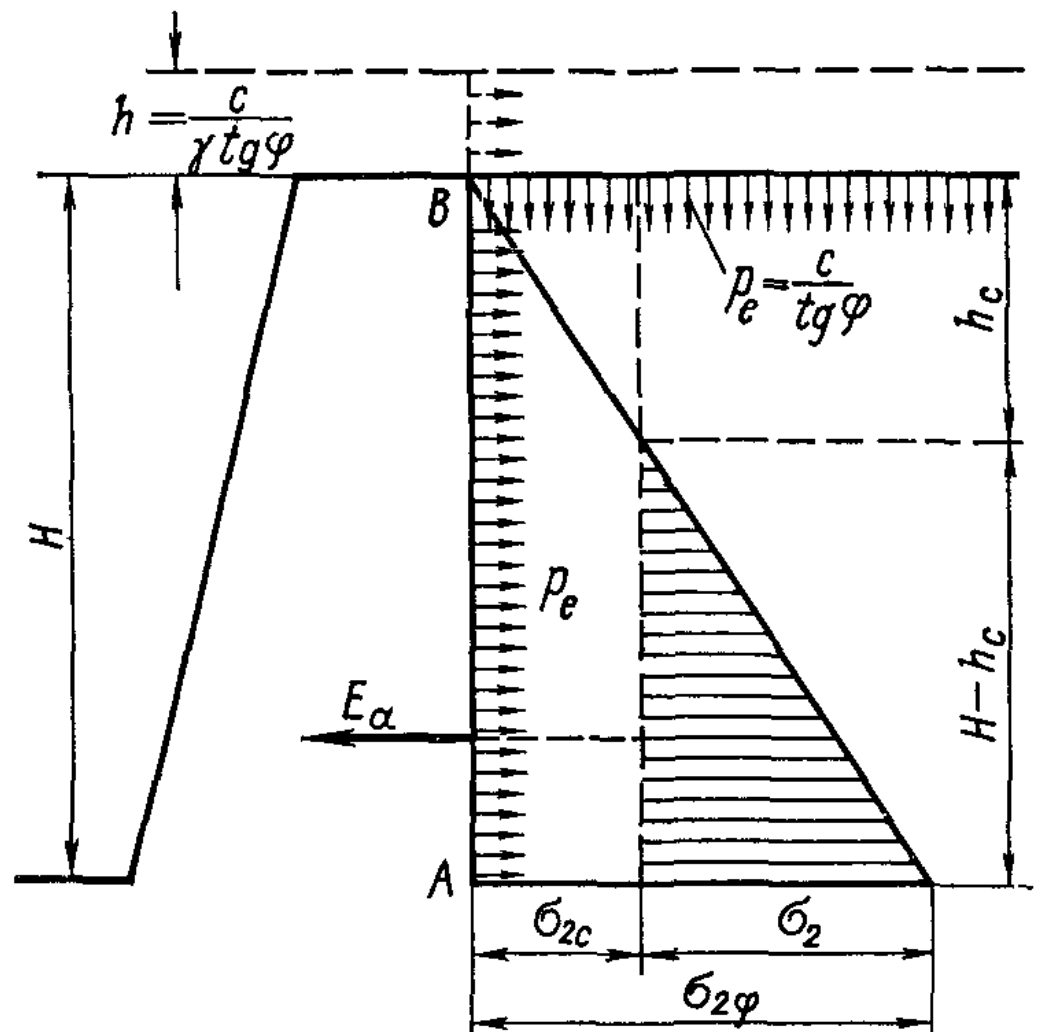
К определению давления связных грунтов на вертикальную гладкую стенку
